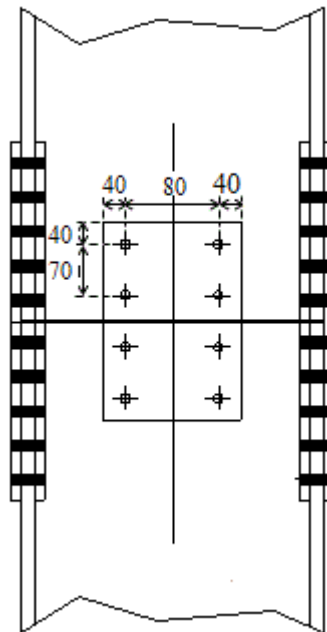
assemblage poteau-poteau (HEB300-HEB300)
